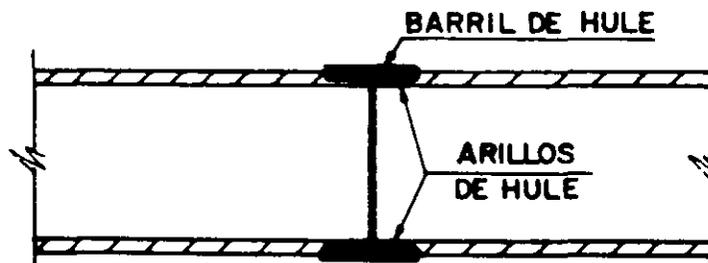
UNION EN TUBERIAS DE ASBESTO - CEMENTO
